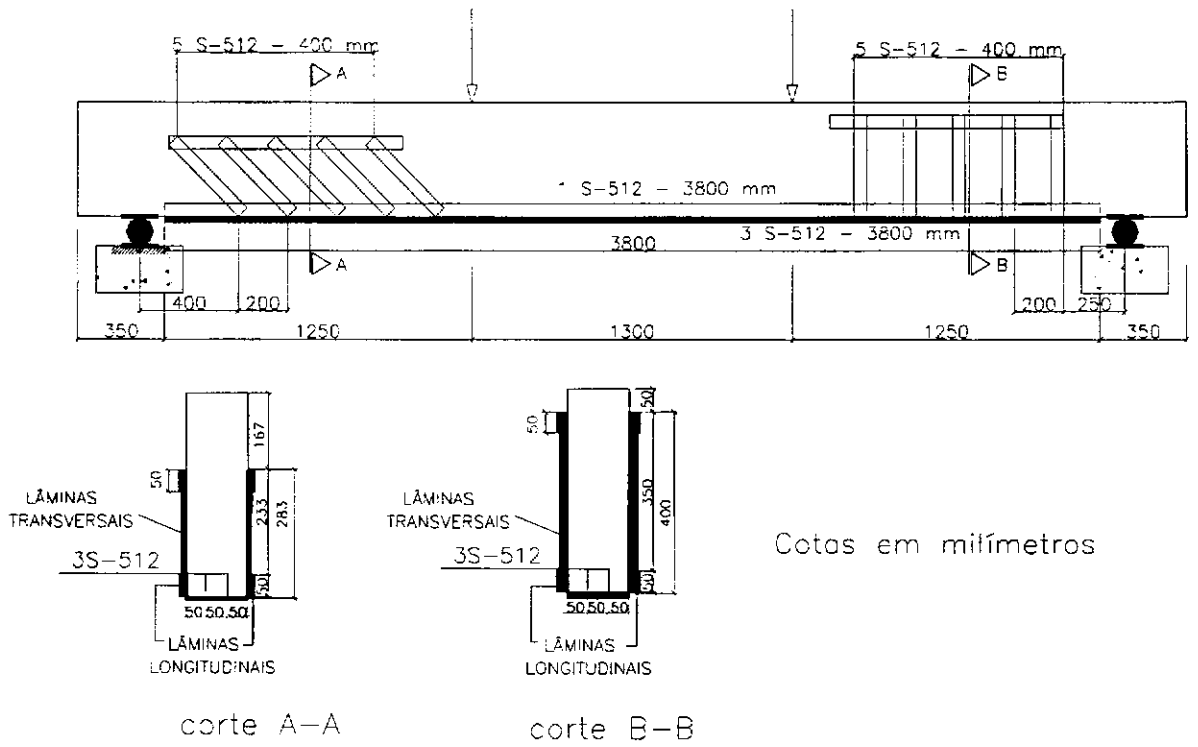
Detalhamento da armadura externa de reforço da viga V5
